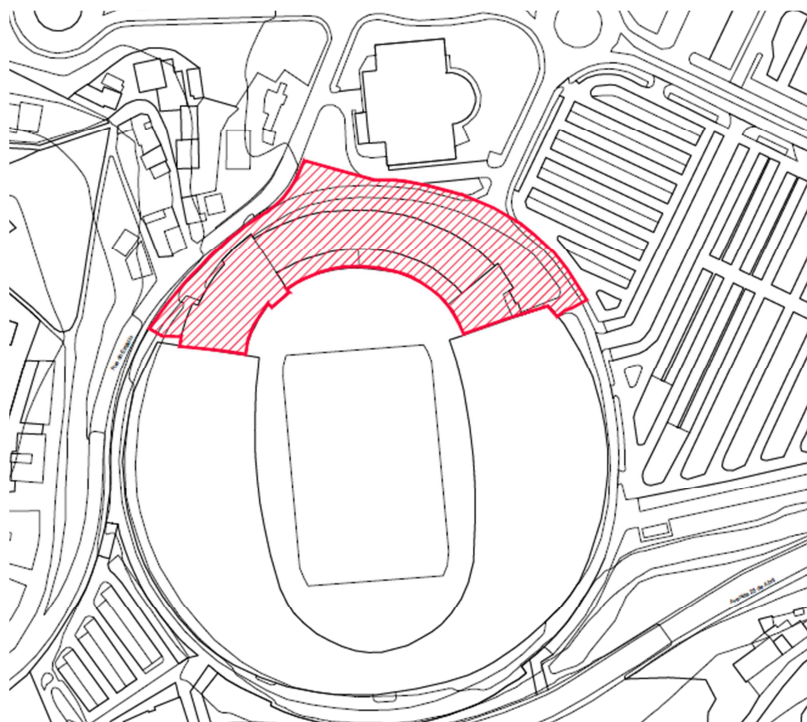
Área de intervenção (excerto da planta “Área de intervenção” que se encontra no Anexo VI)
